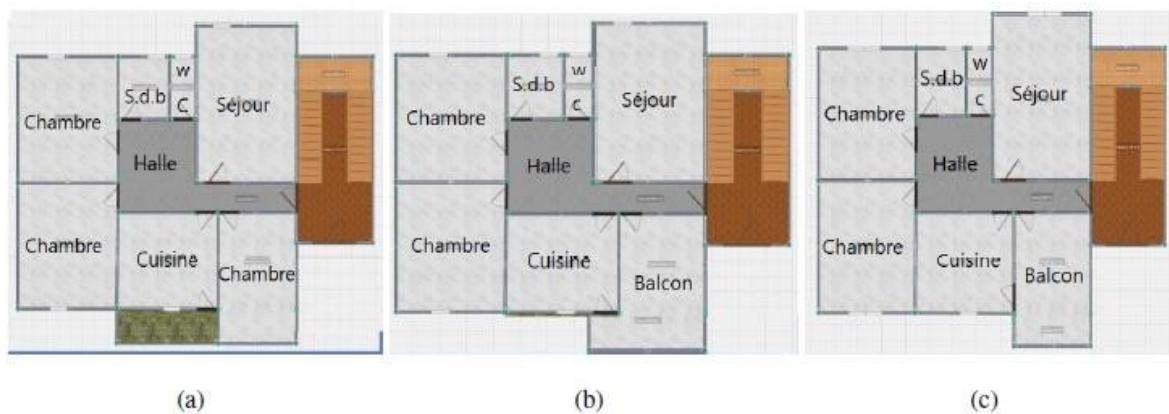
(a) Plan d'appartement f4 (b) Plan d appartement f3 (c) Plan d appartement f3'
